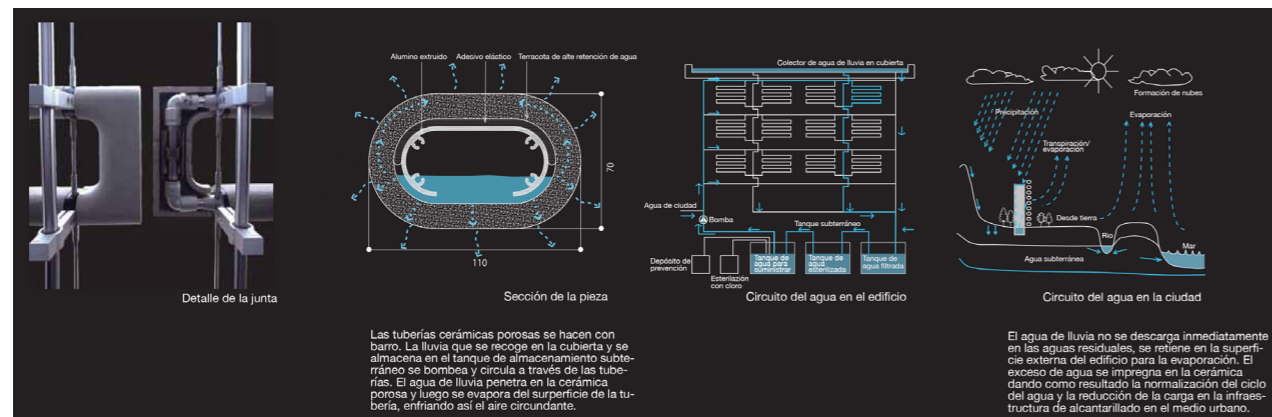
| Diagramas fachada de NBC Osaki Building. Fuente: Nikken Sekkei Ltd.
